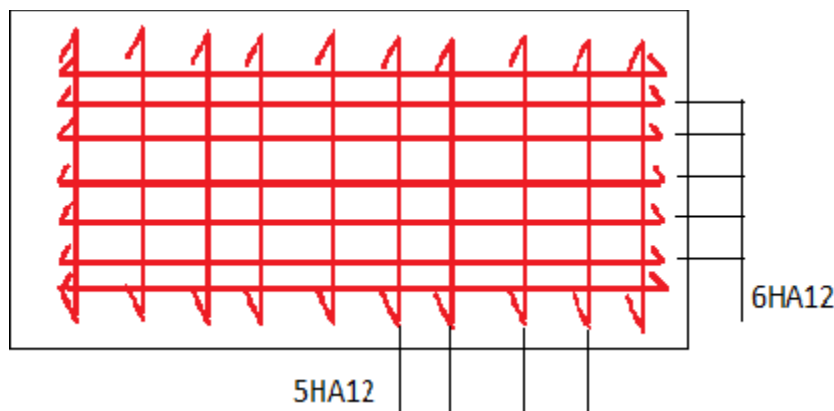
Schéma de Ferrailage de Semelle filante
